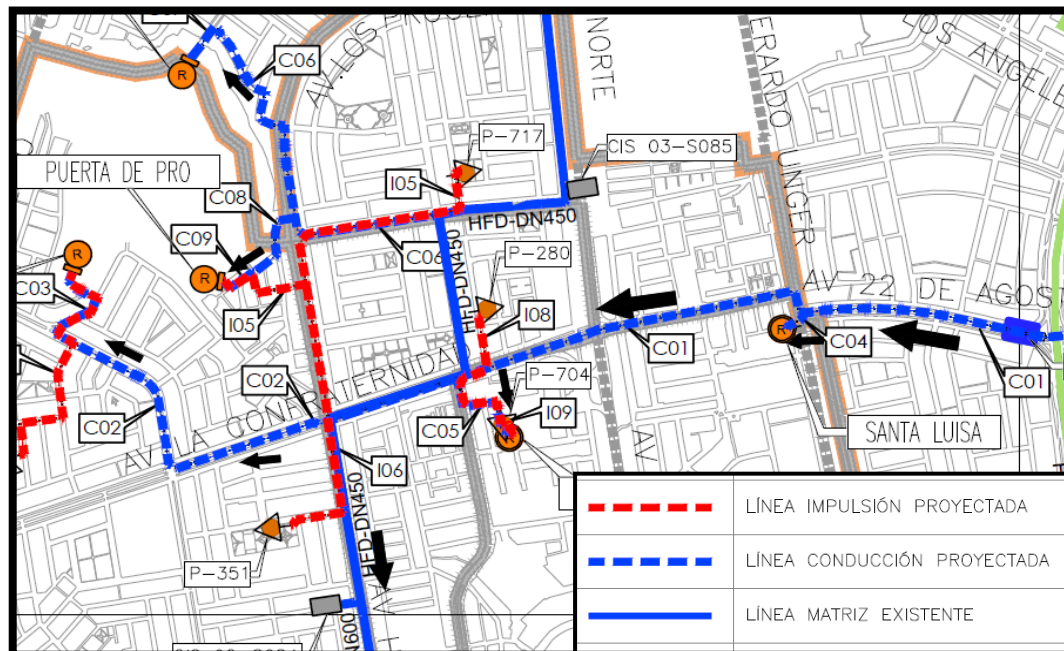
Ubicación de la línea de conducción LC-01 (Fuente: Plano Lima Norte II Lote 1)
